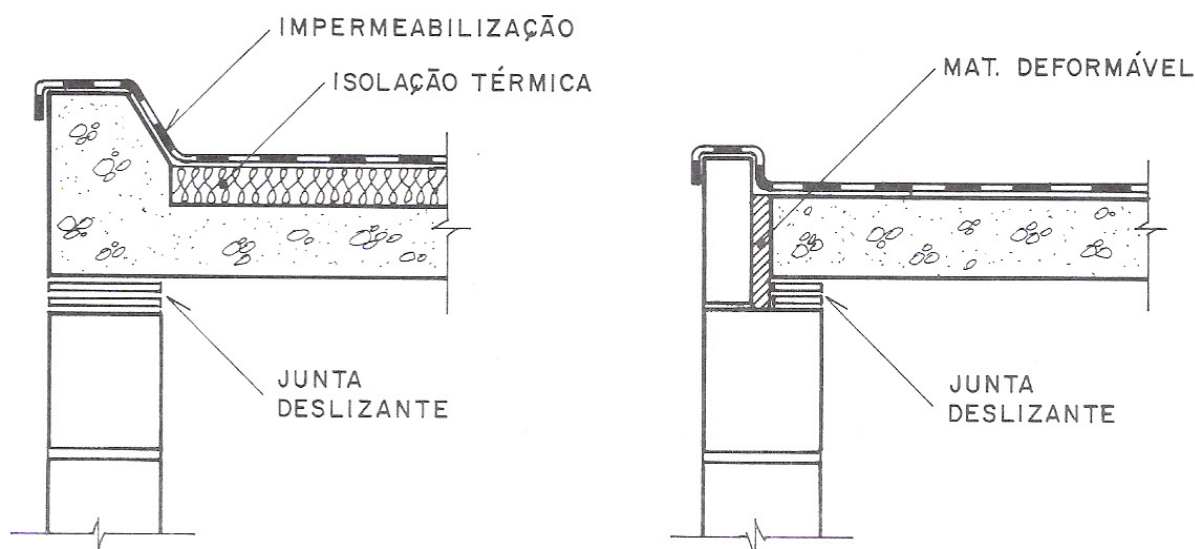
dispositivos para prevenção de fissuras nas paredes do último pavimento (THOMAZ, 1989, p. 144)
